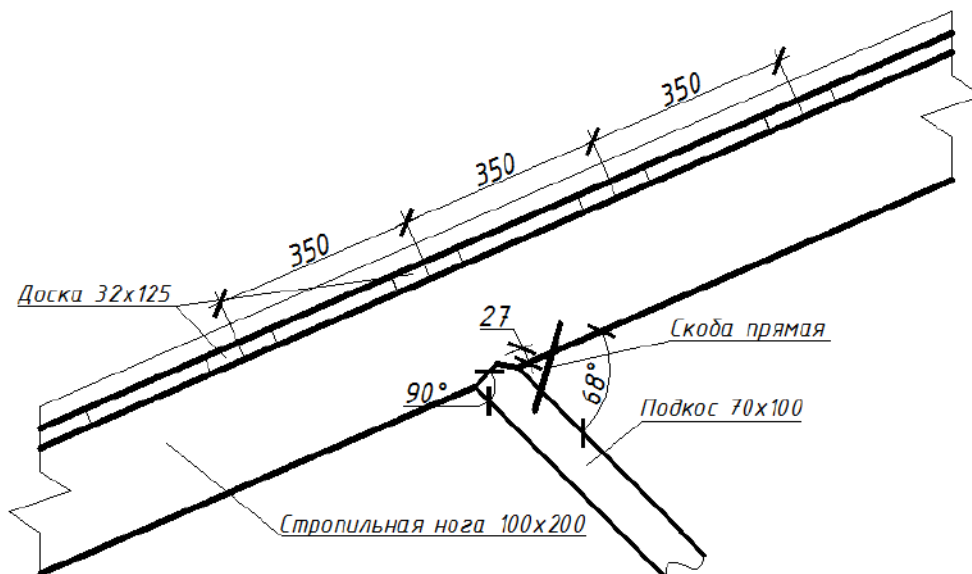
Соединение подкоса со стропильной ногой на врубке
